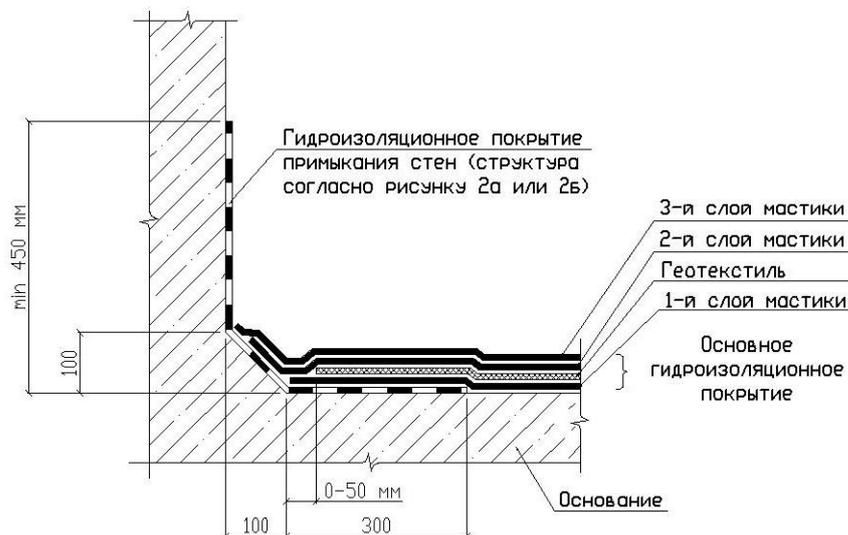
Устройство гидроизоляции в узле примыкания до нанесения основного кровельного покрытия.
